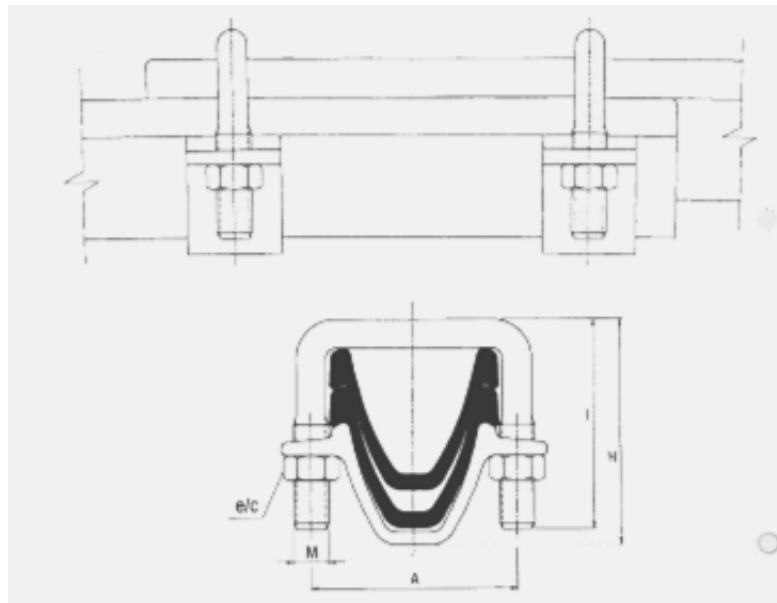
Esquema de ligação dos perfis (Fonte: PTRE)
